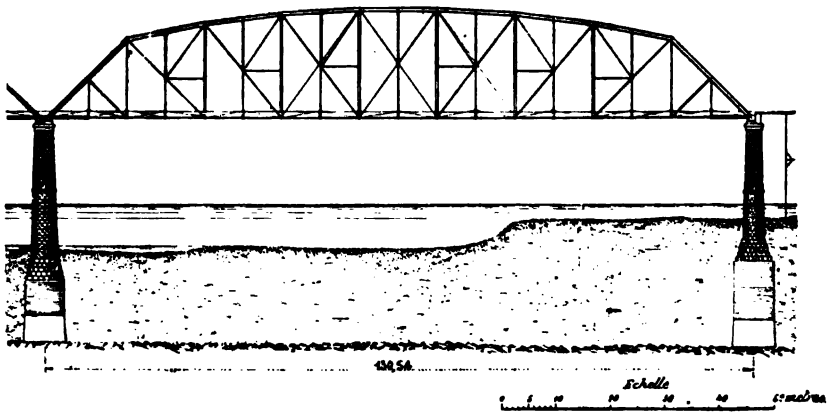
Travée de 130^m,54 du Winner Bridge.
